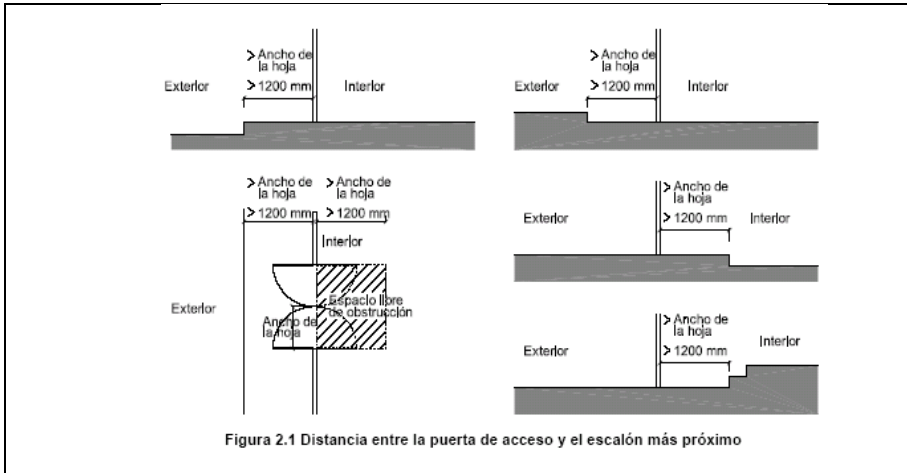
Distancia entre la puerta de acceso y el escalón más próximo
